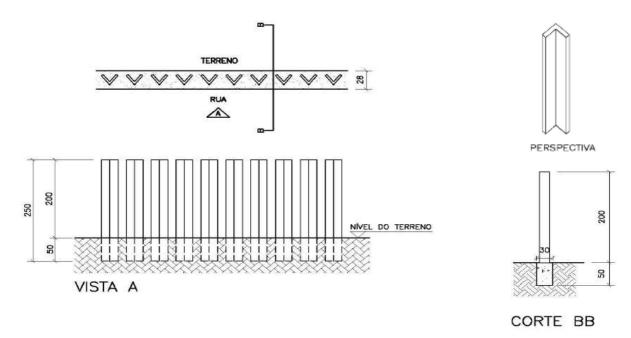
Demonstração esquemática do muro pré-moldado com calhas de concreto em "V".
